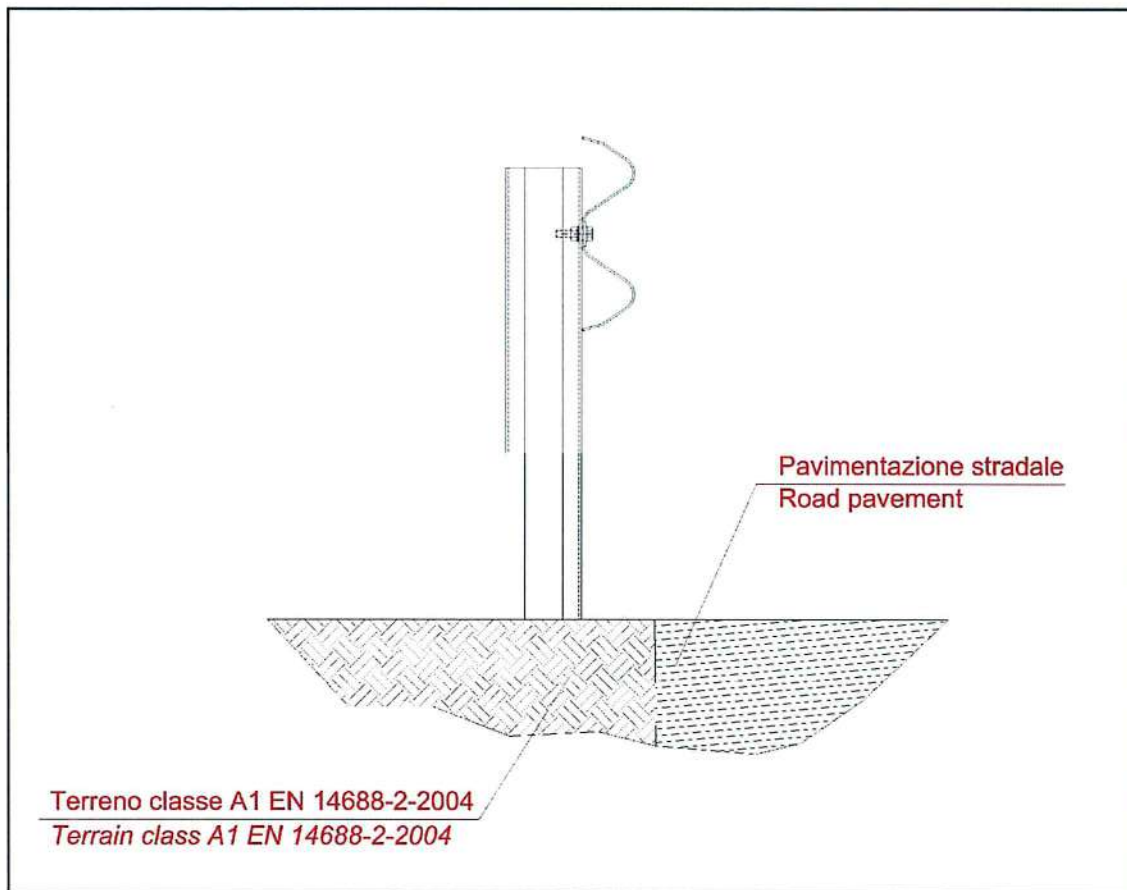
Figure 2 Sezione dell'installazione – The installation section
